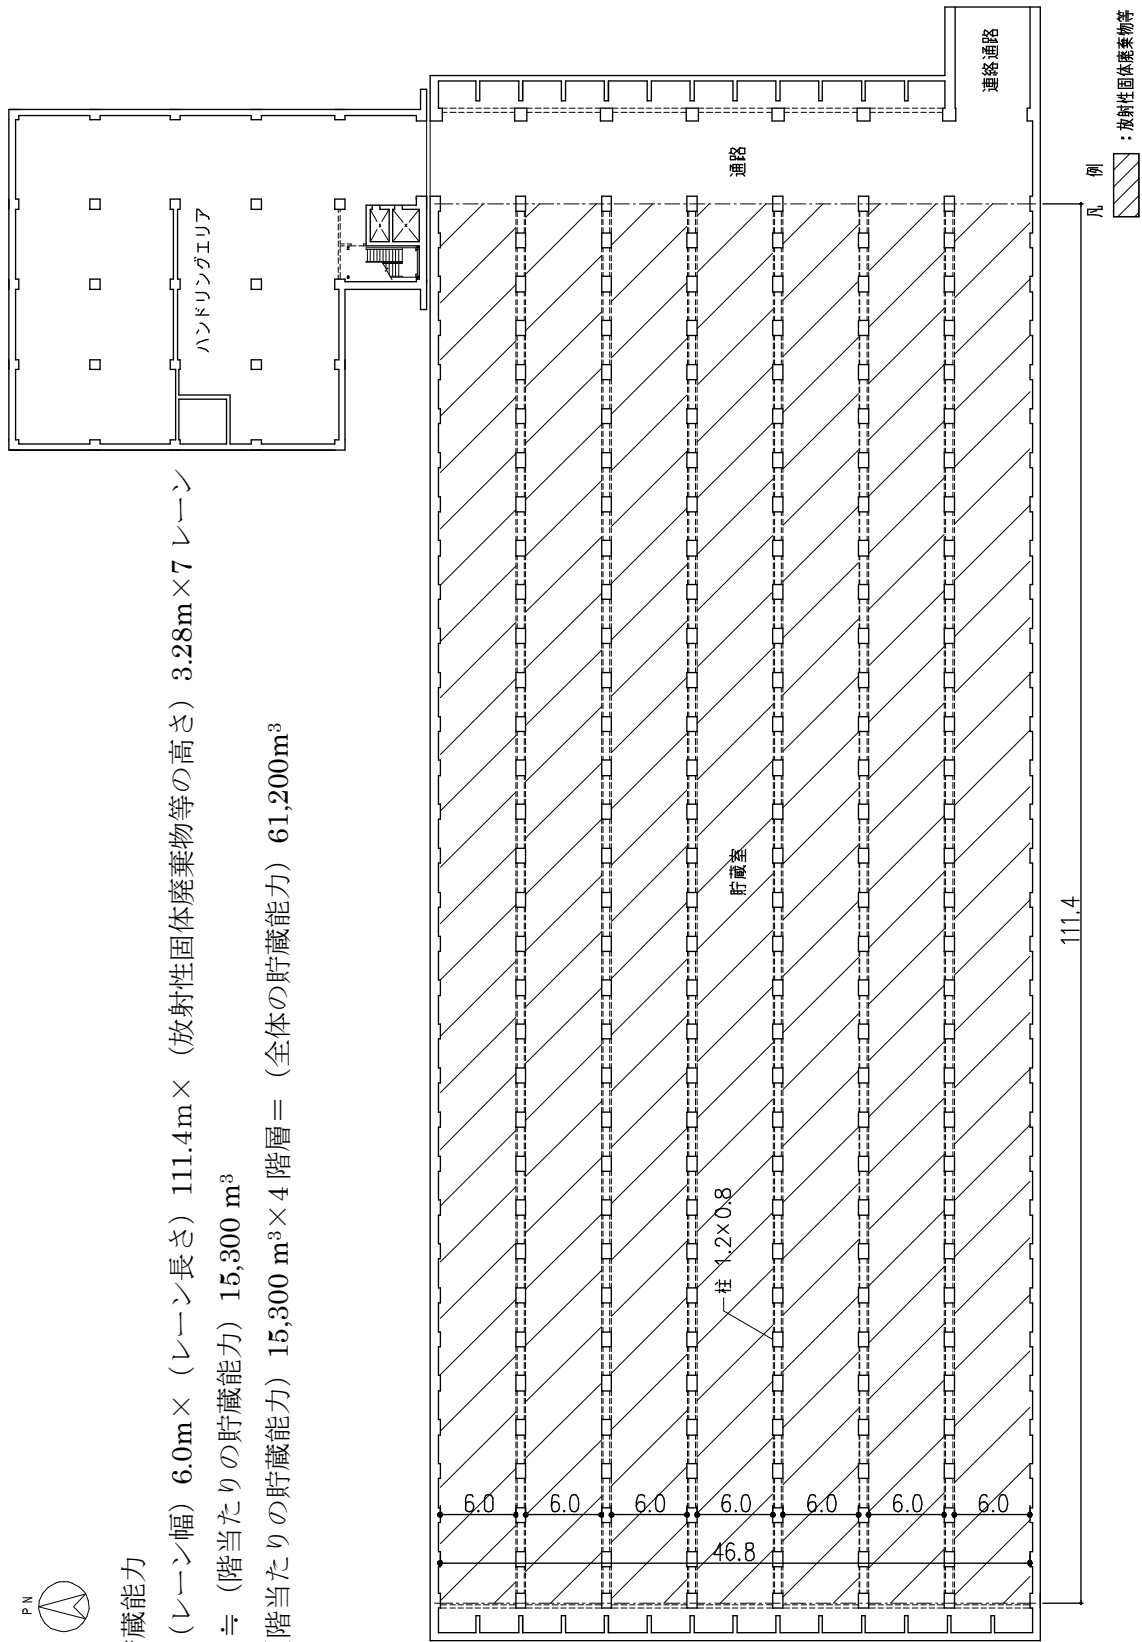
固体廃棄物貯蔵庫第9棟 地下2階 平面図 (単位: m)
